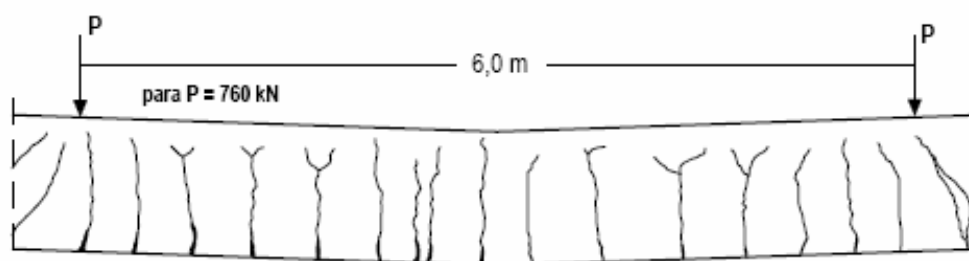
VIGA DE CONCRETO COM PROTENSÃO ADERENTE, SUJEITA A UM CARREGAMENTO
